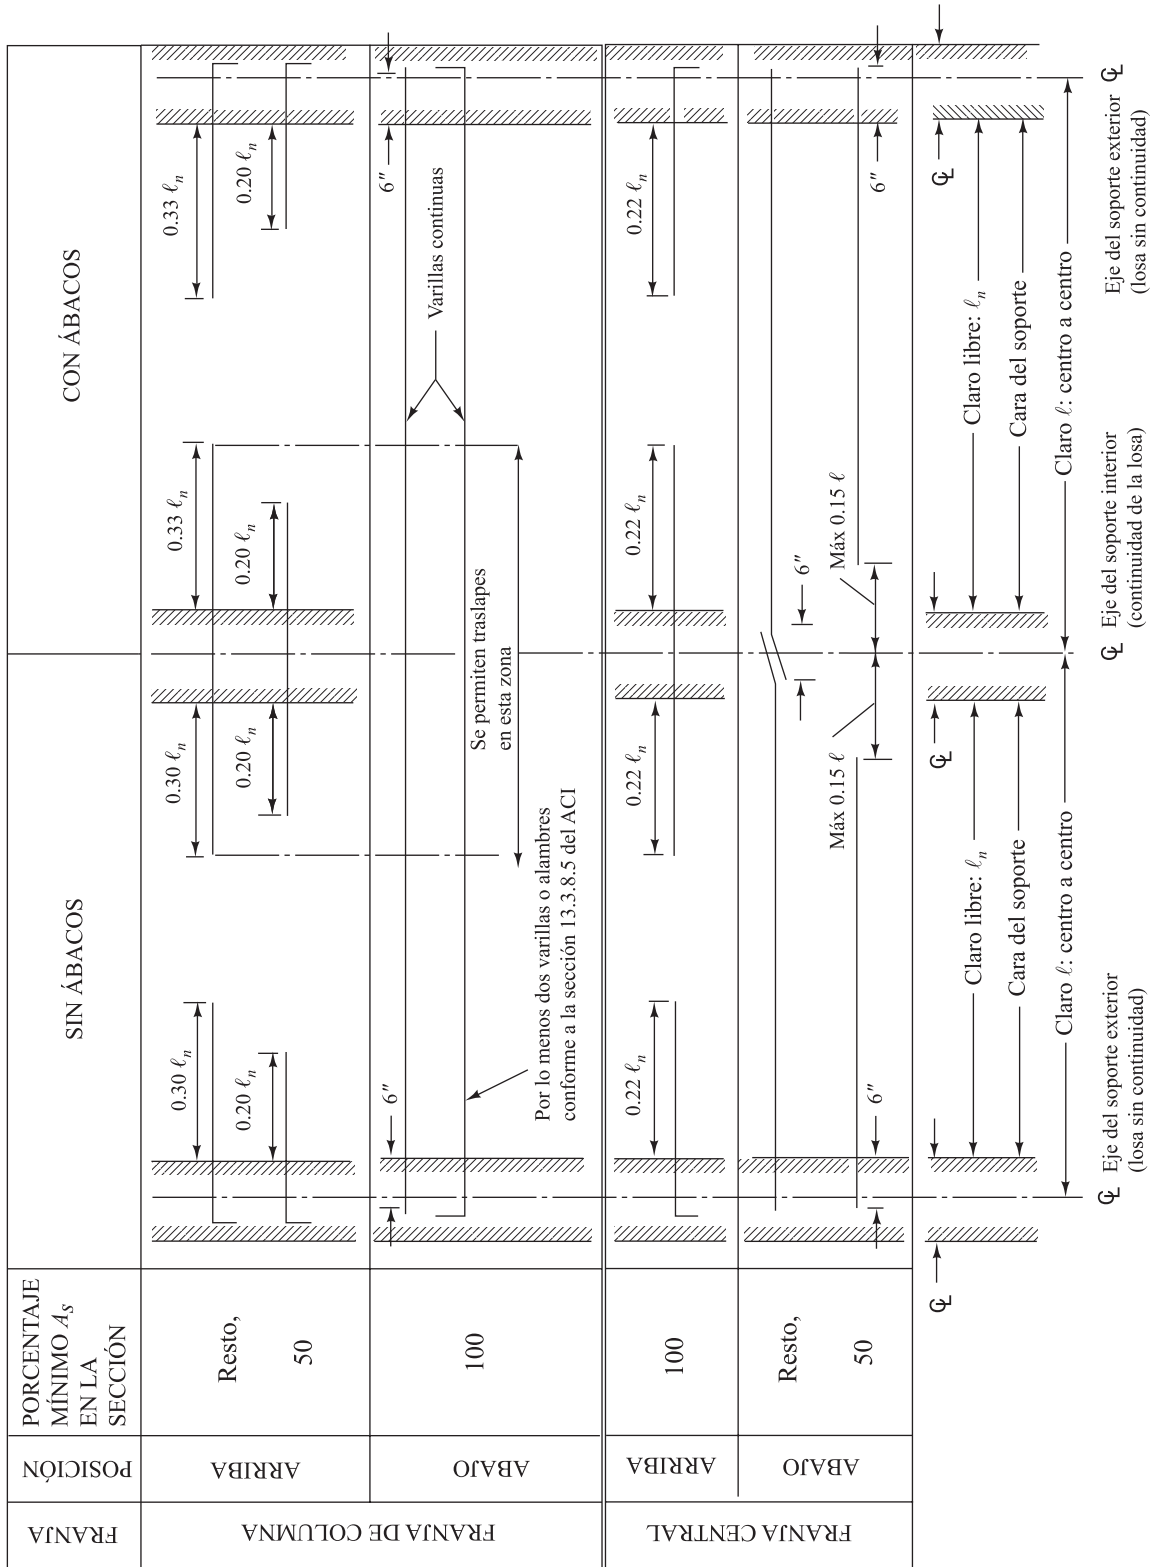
Extensiones mínimas para el refuerzo en losas sin vigas (véase la Sección 9.7.3.8 del Código ACI para la extensión del refuerzo en los soportes).
